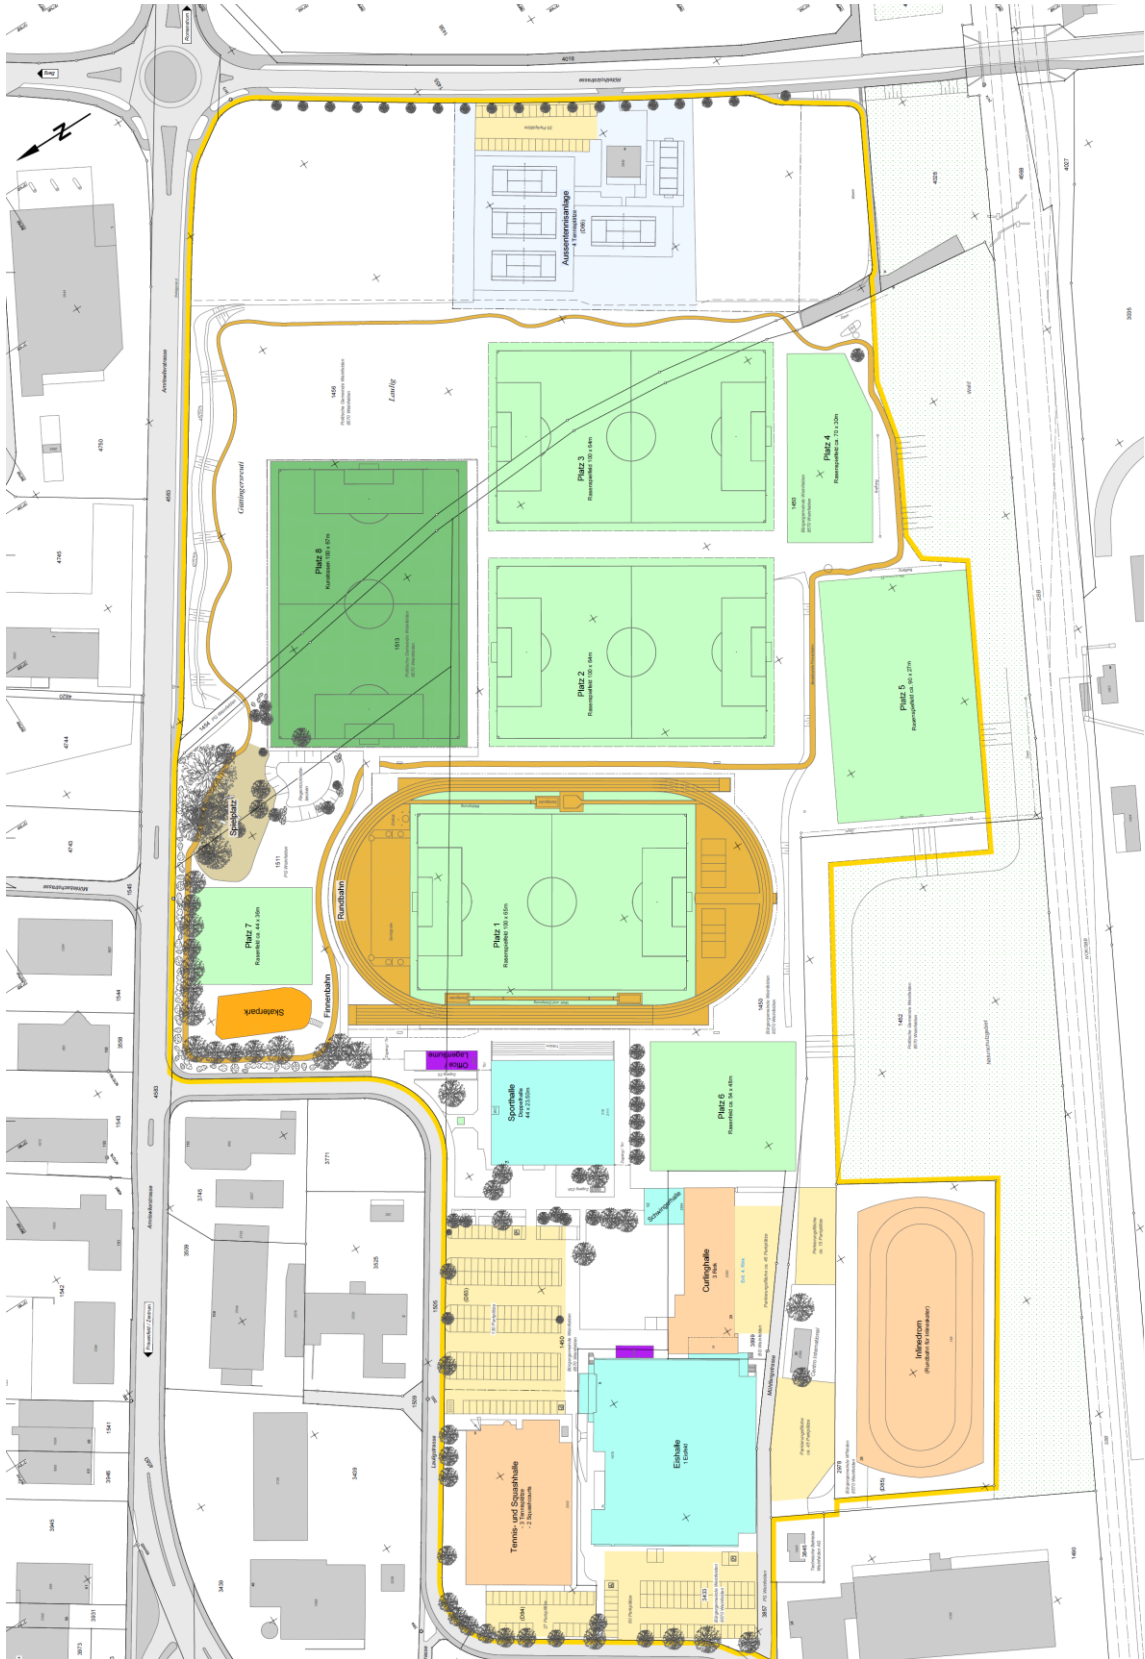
Übersichtsplan mit Anlagenbezeichnung
